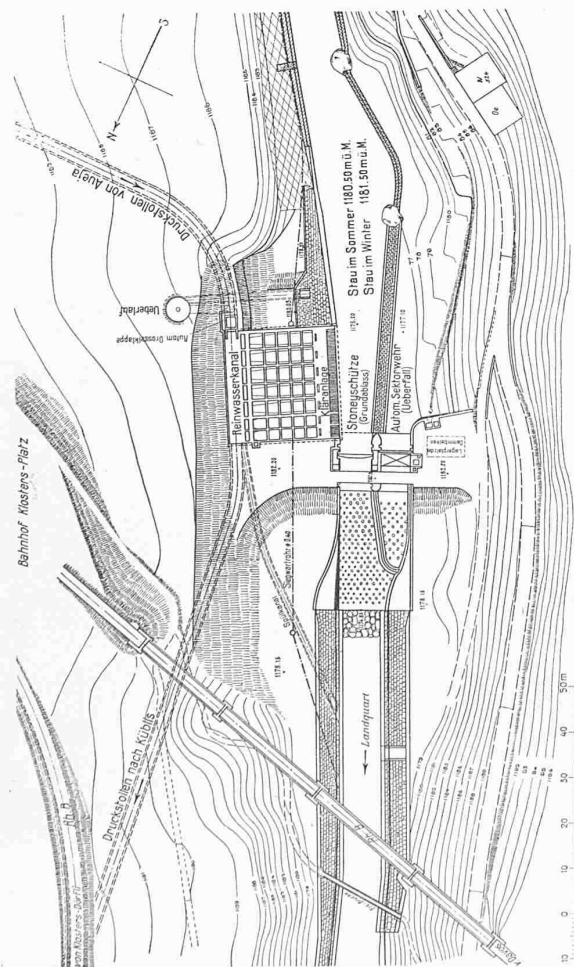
Lageplan der Wehr- und Kläranlage Klosters.
